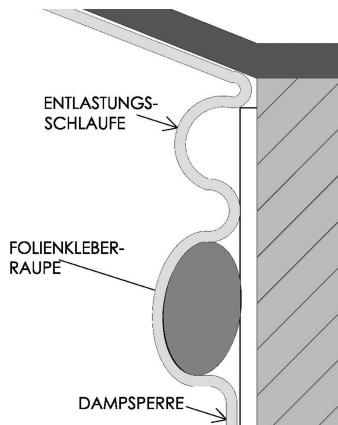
Richtige Ausführung Anschluss Dampfbremse an umgebende Bauteile bzw Rohrdurchführungen
